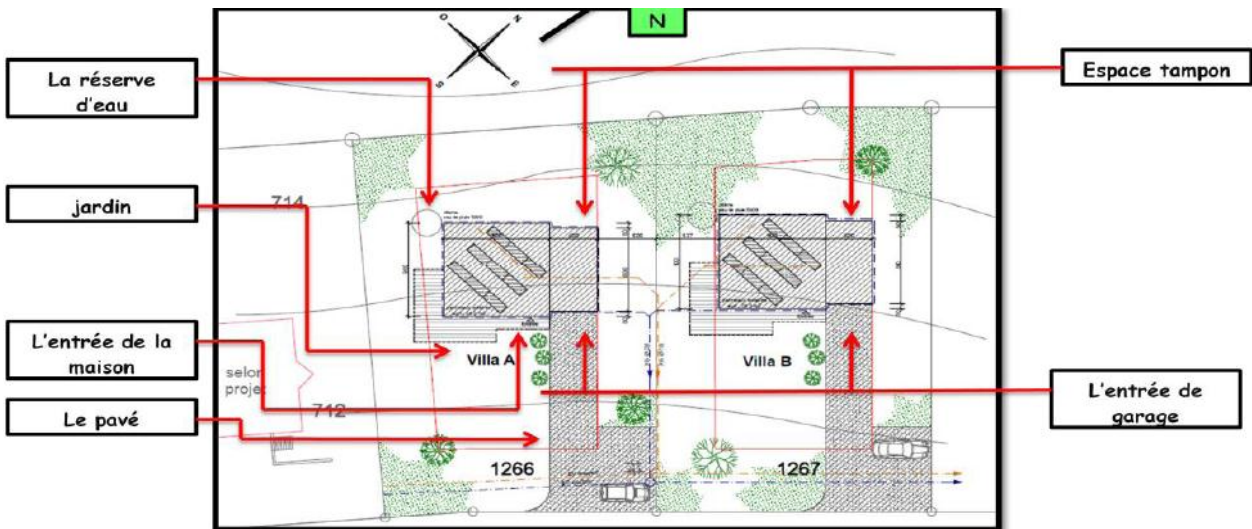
Plan de Masse, Source : <http://lab-immo.ch/1037/> - Minergie-P-ECO MAISON
